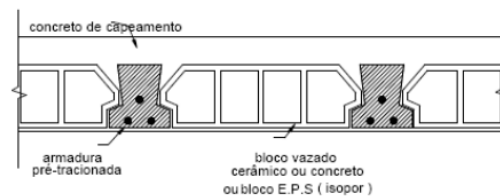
Ilustração da laje pré-fabricada com vigotas treliçadas (CUNHA, 2012).
